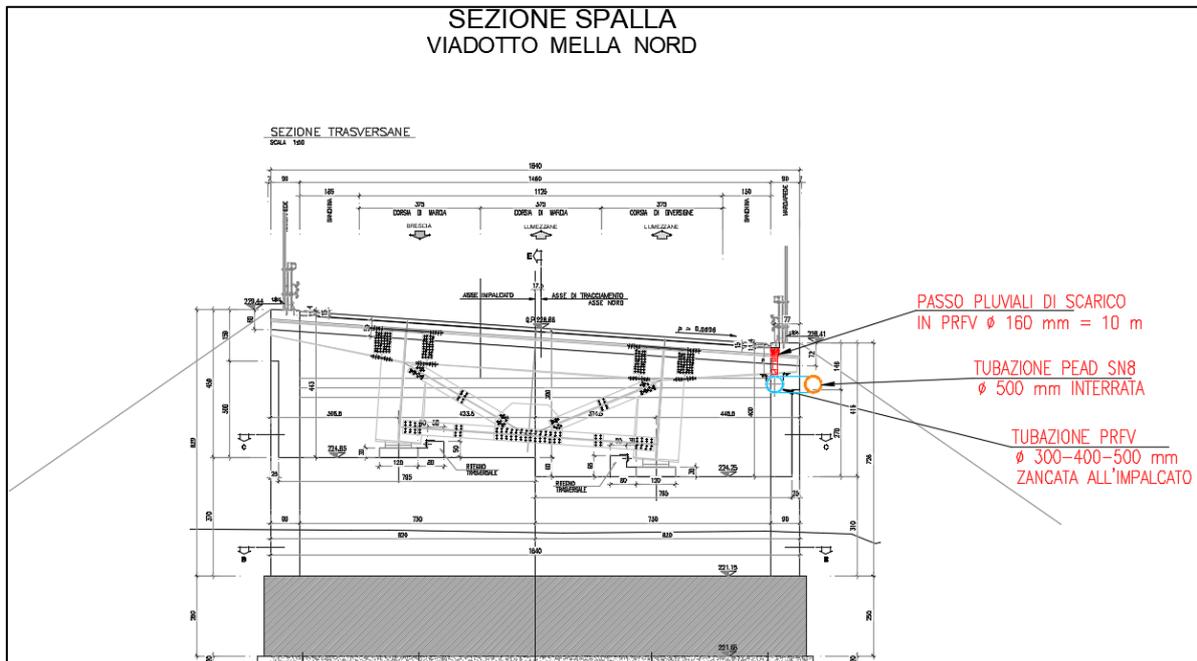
Sistema di smaltimento viadotti. Sezione spalla Viadotto Mella Nord
